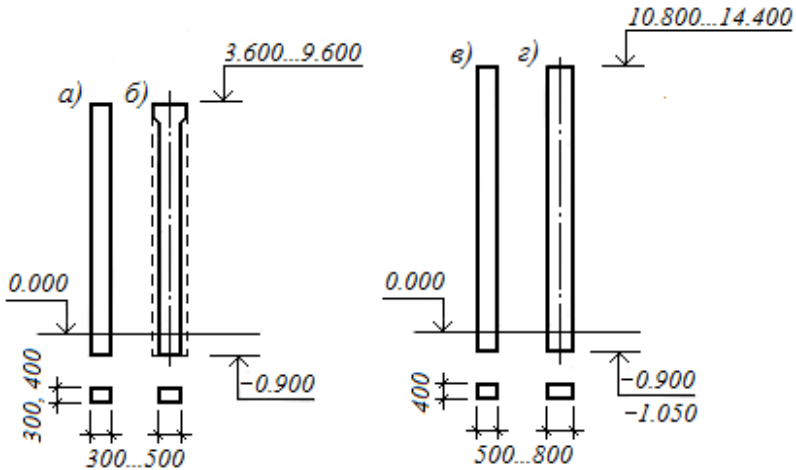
Збірні залізобетонні колони прямокутного перерізу для будівель без мостових кранів: а, в – крайніх рядів; б, г – середніх рядів
